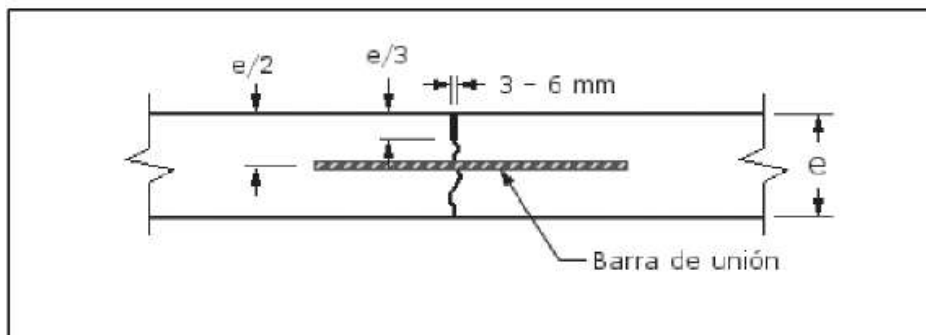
Junta longitudinal de contracción o articulación con barras de unión.
